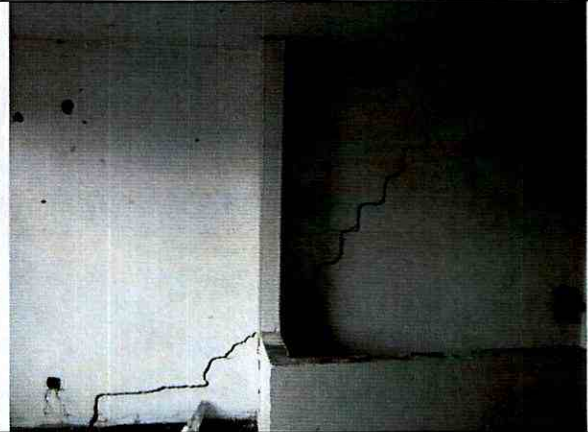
Grieta diagonal en muro de segundo piso.
